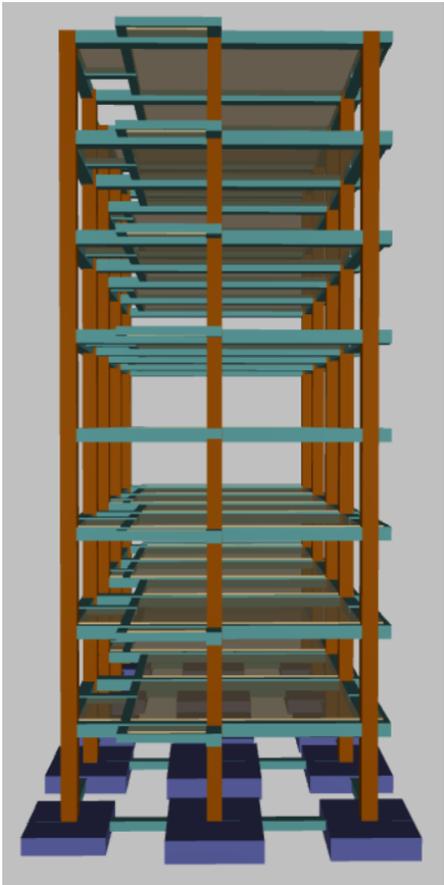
VISTA 3D DEL EDIFICIO.
